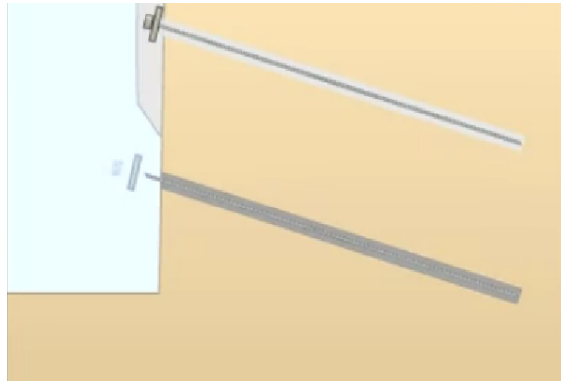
Execució Soil Nailing. Col·locació placa de repartiment (Font: www.youtube.com)
